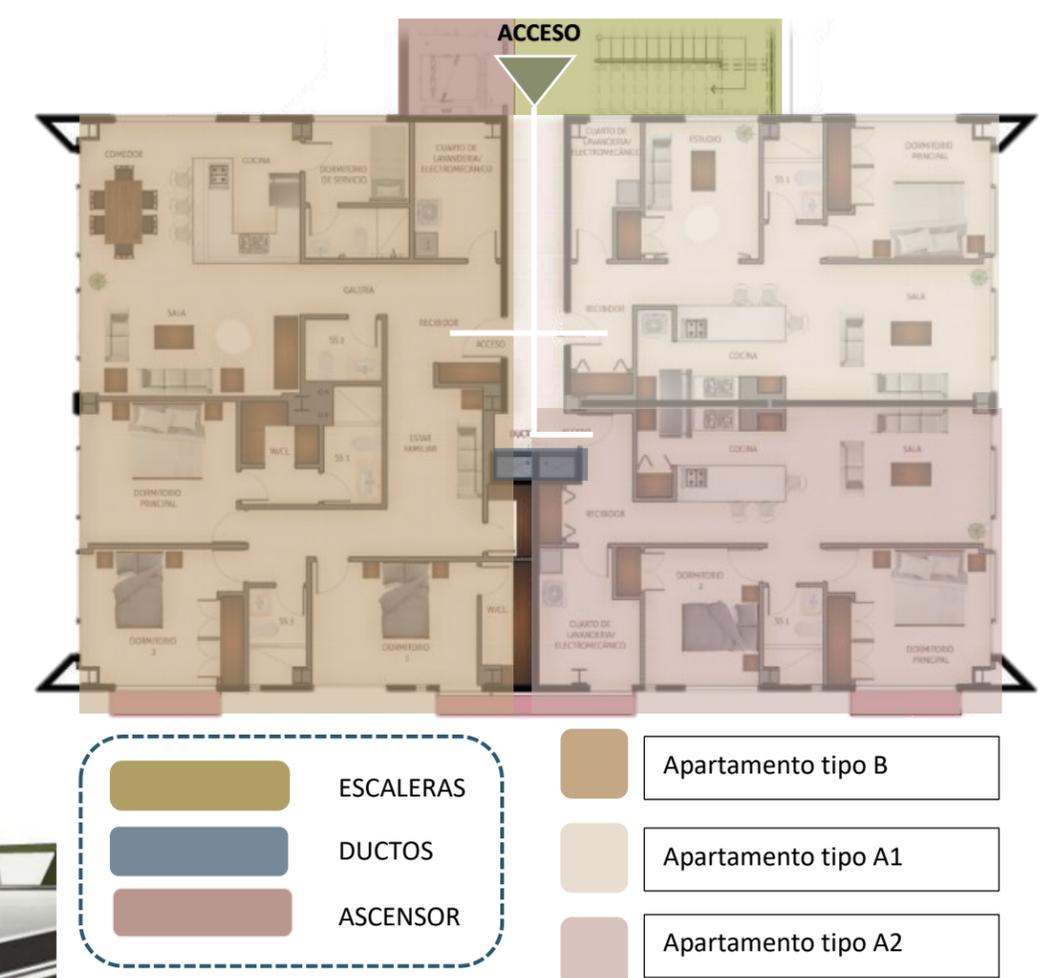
Zonificación / Planta torre 1. Fuente: Kelton Villavicencio Arquitectos.
